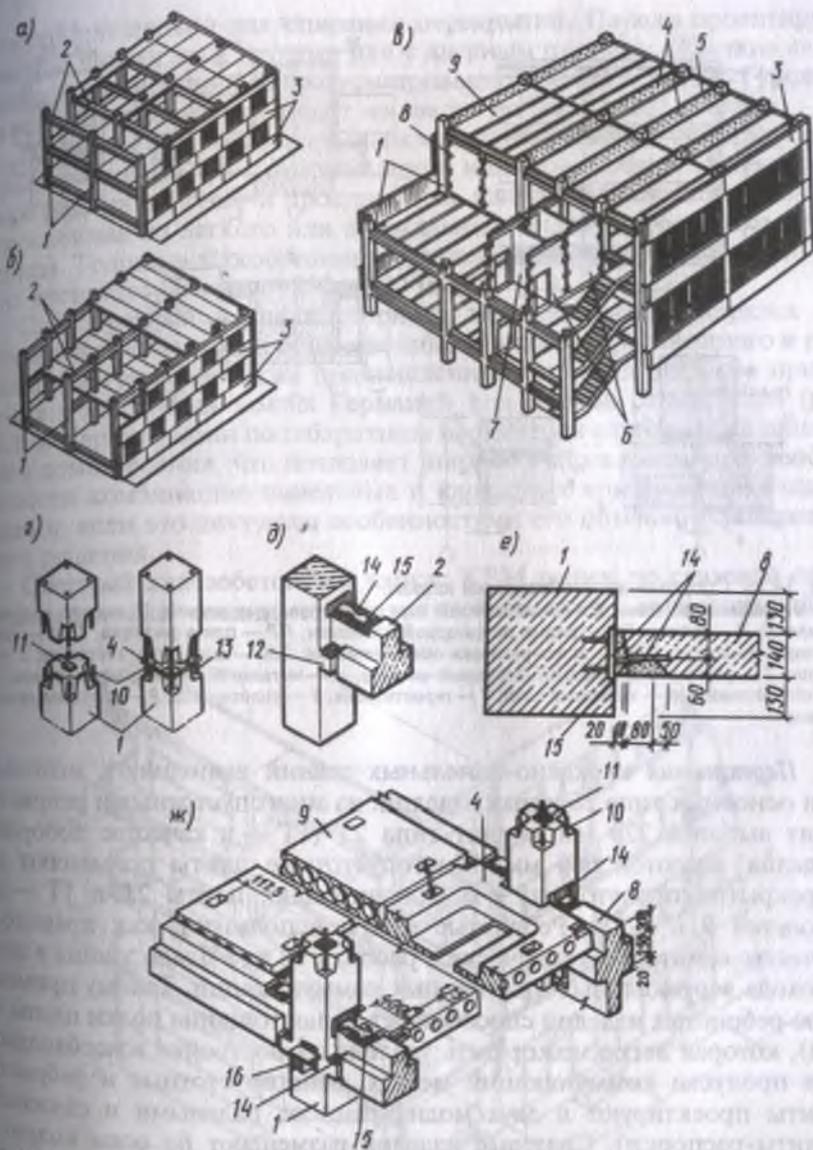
Компонка и узлы сборного железобетонного каркаса:
